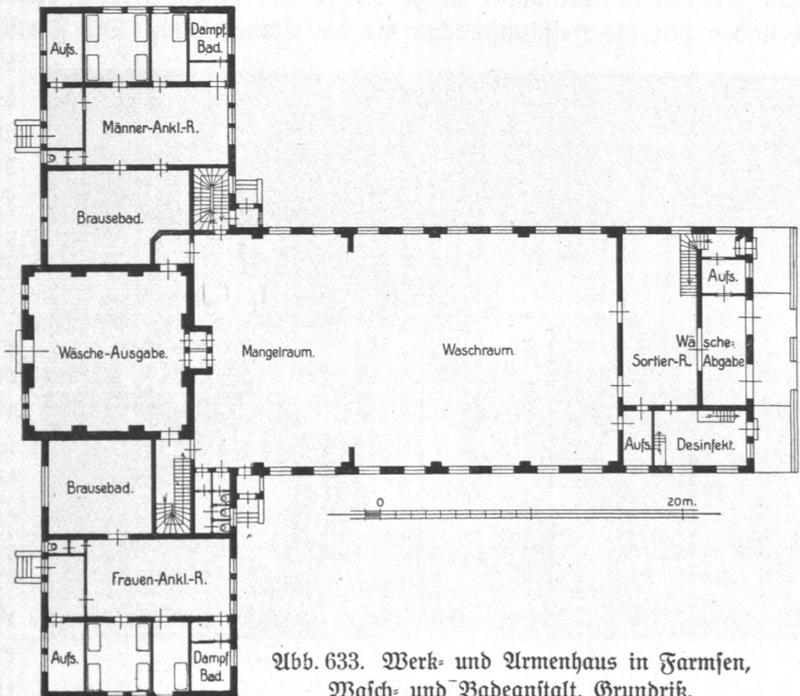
Werk- und Armenhaus in Farmsen, Wasch- und Badeanstalt, Grundriß.
